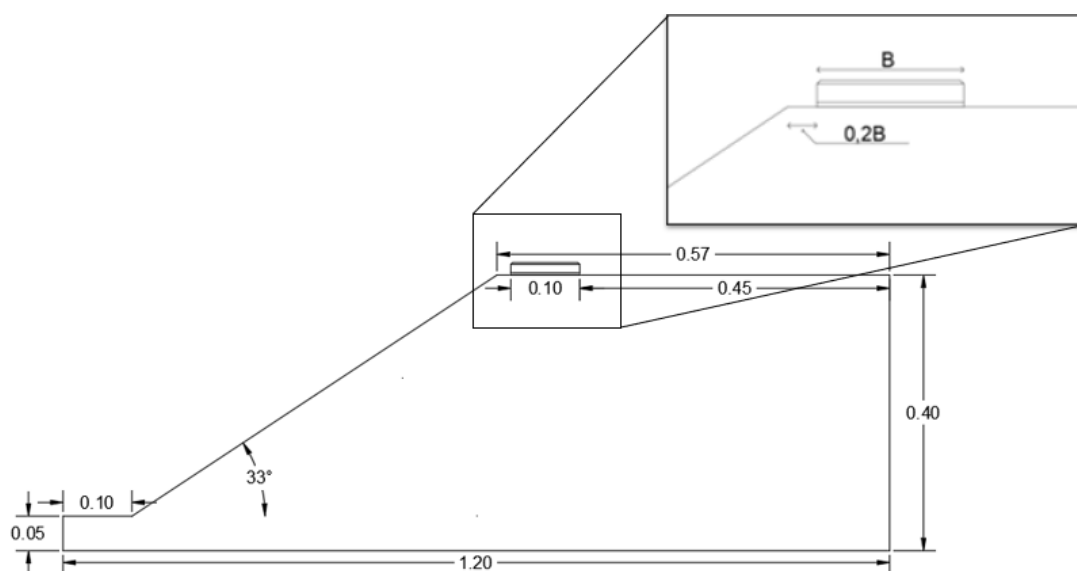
Geometria e disposição da fundação no talude base, figura em metros
